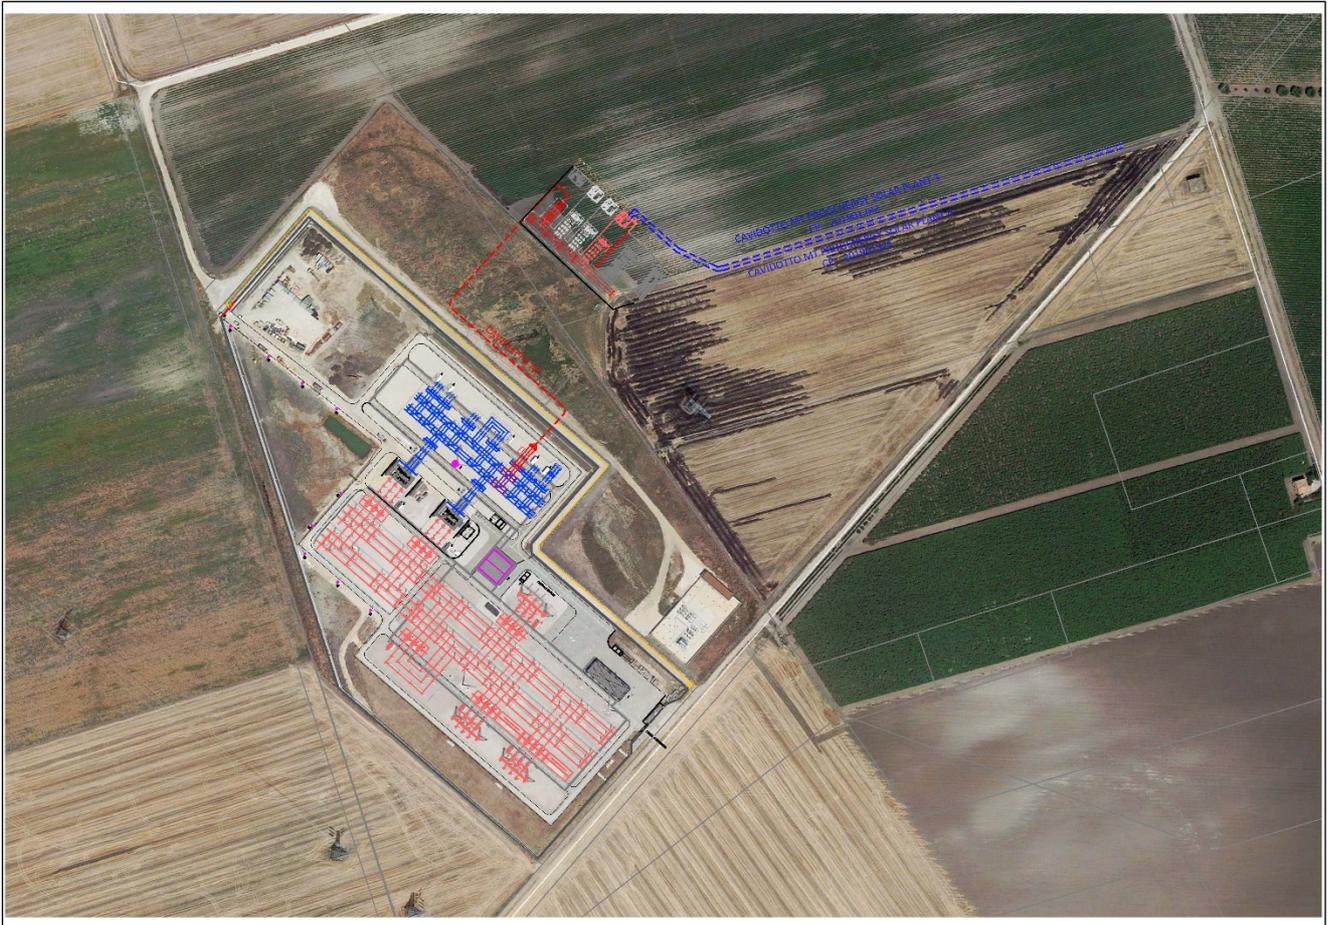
Planimetria su Ortofoto della SE Terna "San Severo".
